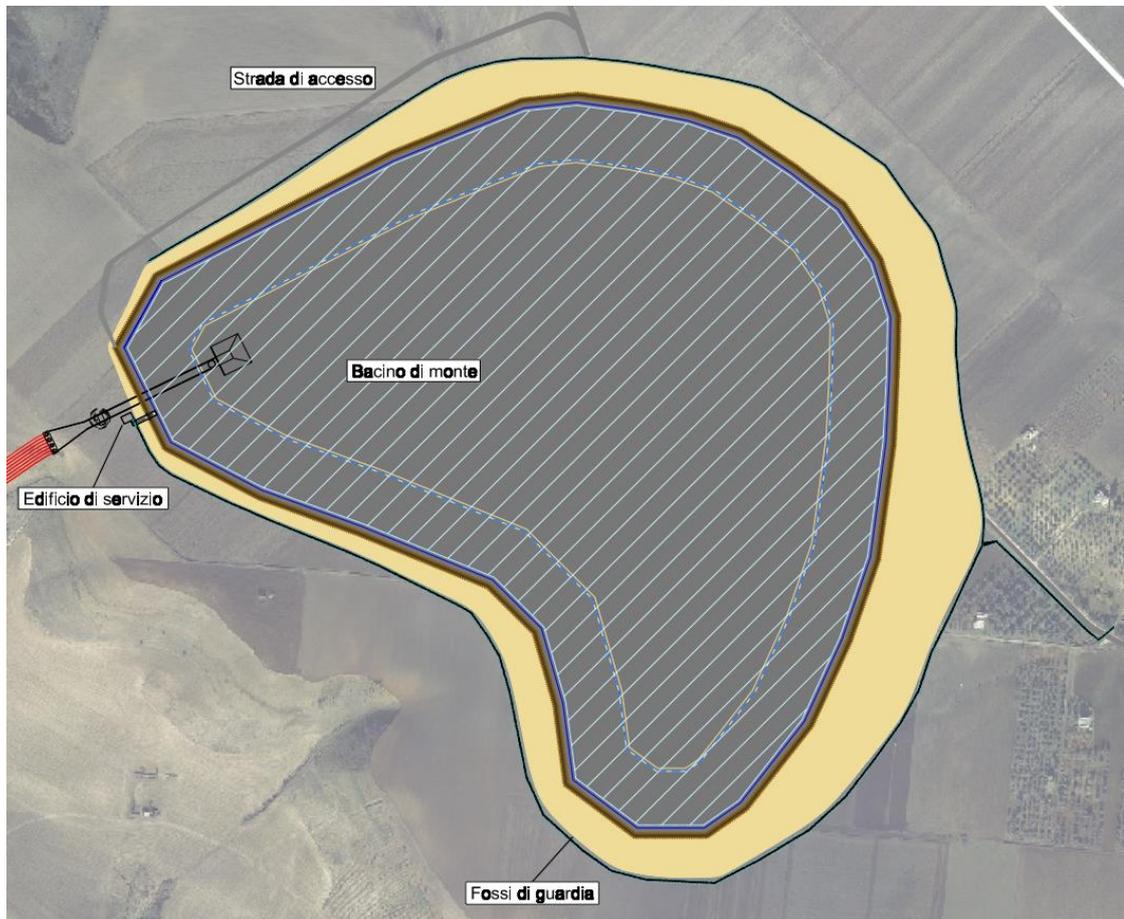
Planimetria di progetto del bacino di monte (estratto Tavola PD-EP-3.1).
